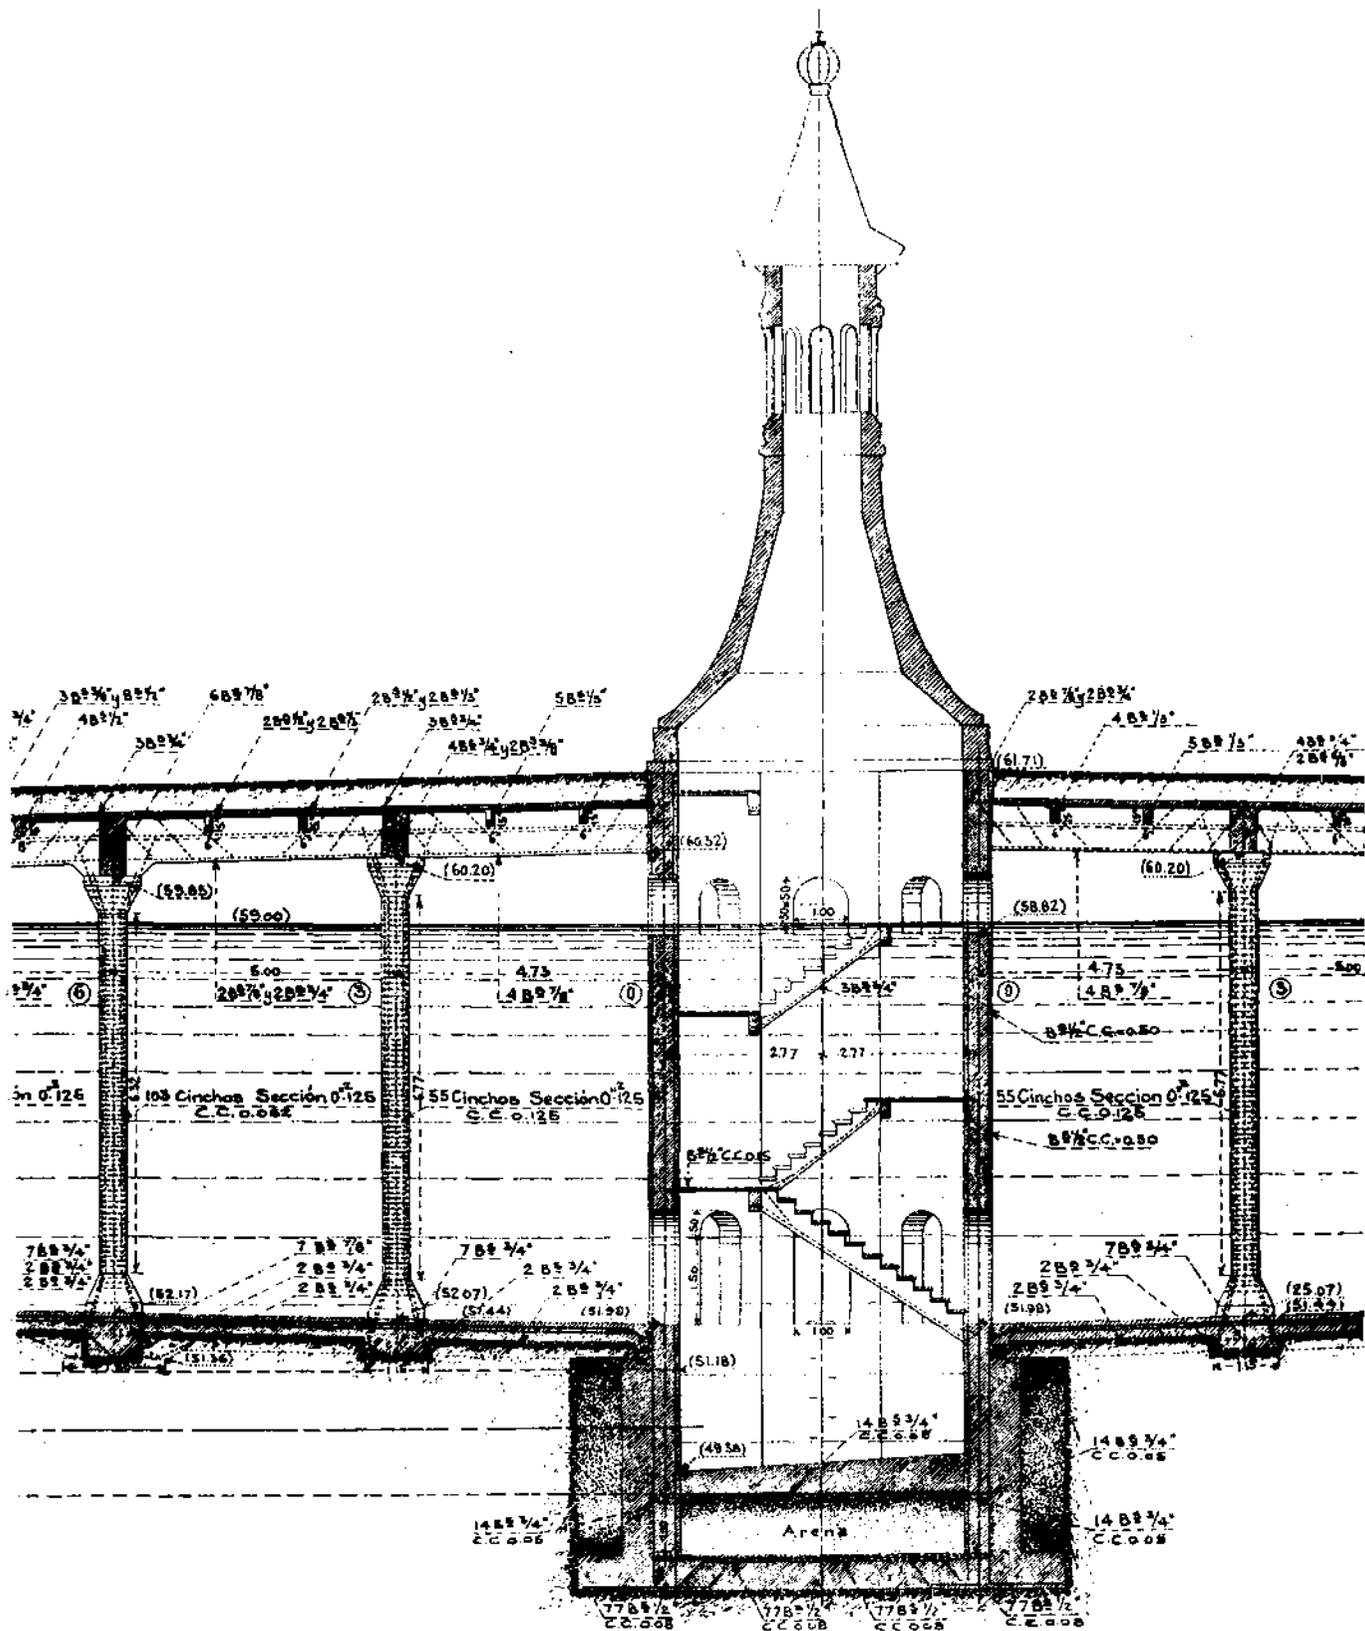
Corte longitudinal de un tanque regulador (Marroquin)
